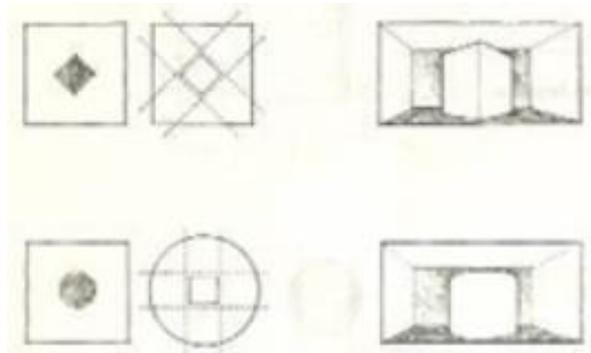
Bentuk Hubungan Ruang - Ruang di Dalam Ruang
